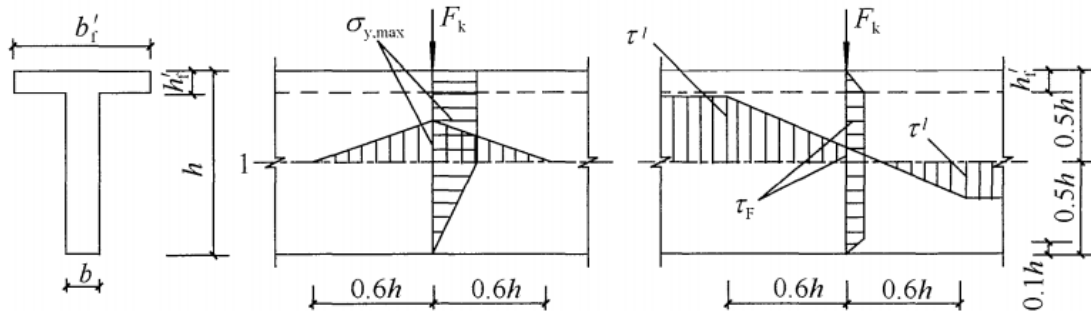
预应力混凝土吊车梁在集中力作用点附近的应力分布
